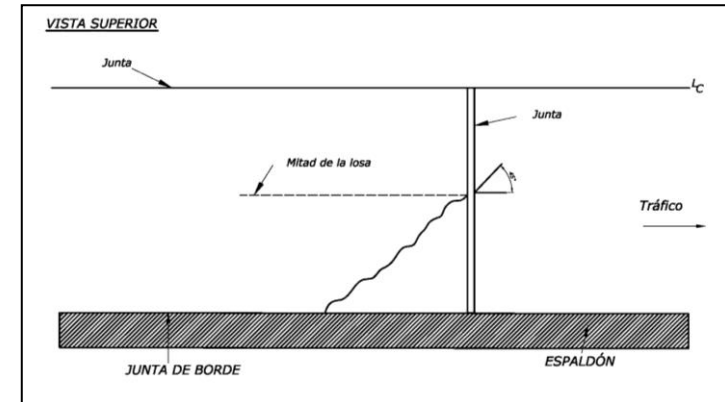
Esquema Grieta de Esquina- Pavimento Rígido
